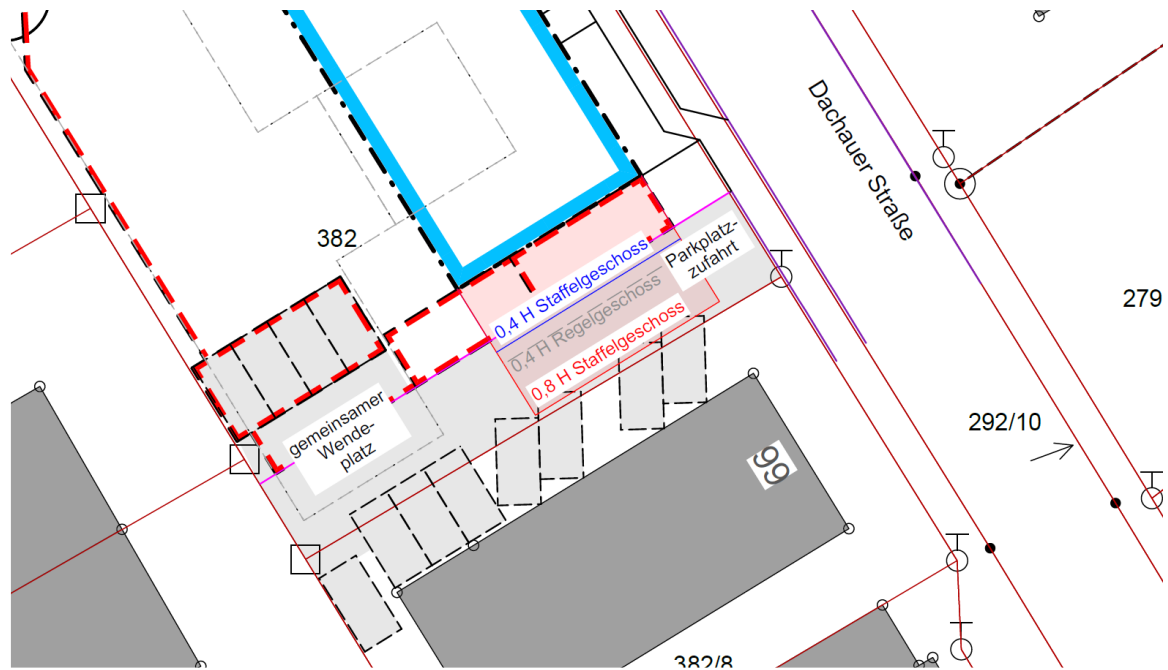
Reduzierte Darstellung der Bebauungsplaninhalte (Flurkarte, Geltungsbereich, Baugrenzen) und Darstellung der geplanten, teilweise bestehenden, Stellplatzsituation für die Dachauer Straße 66 sowie Darstellung möglicher gesetzlicher Abstandsflächen nach Süden, ohne Maßstab
